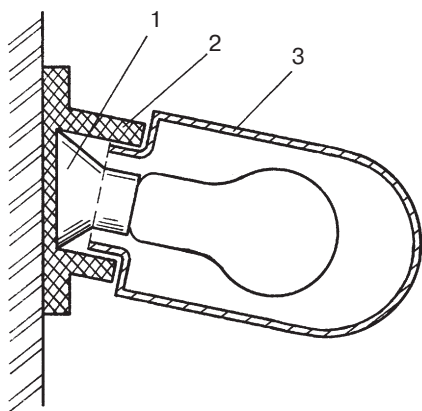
Настенный светильник: 1 — стенной патрон; 2 — корпус; 3 — колпак
